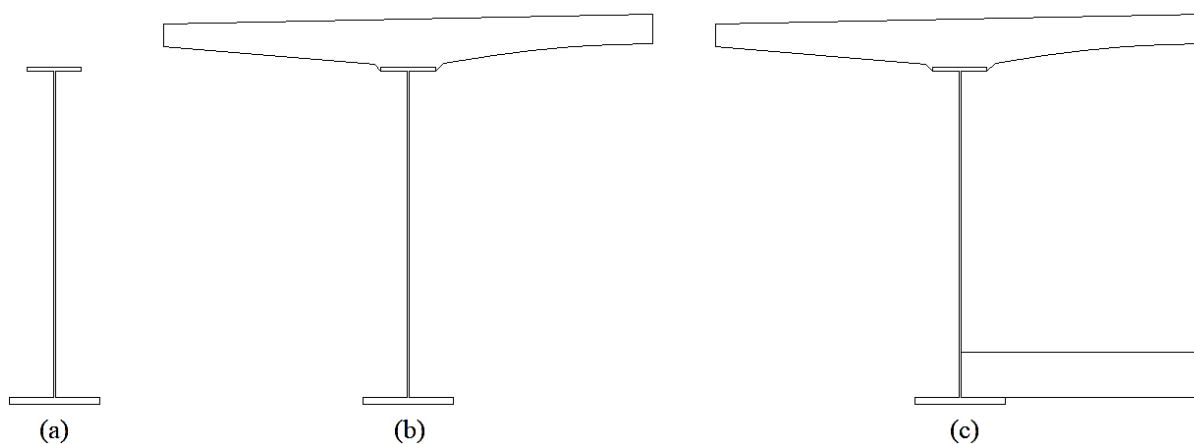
Seções transversais ao longo do processo construtivo - (a) perfil metálico; (b) perfil e laje do tabuleiro; (c) perfil, laje do tabuleiro e laje inferior.
